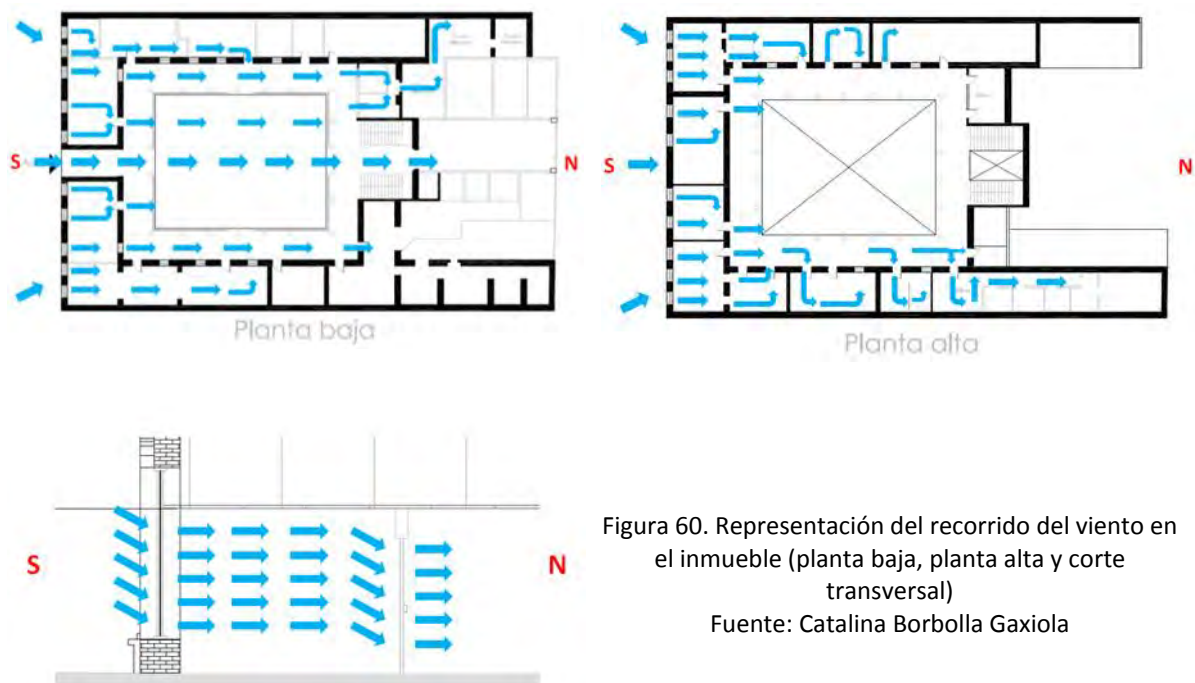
Representación del recorrido del viento en el inmueble (planta baja, planta alta y corte transversal)
